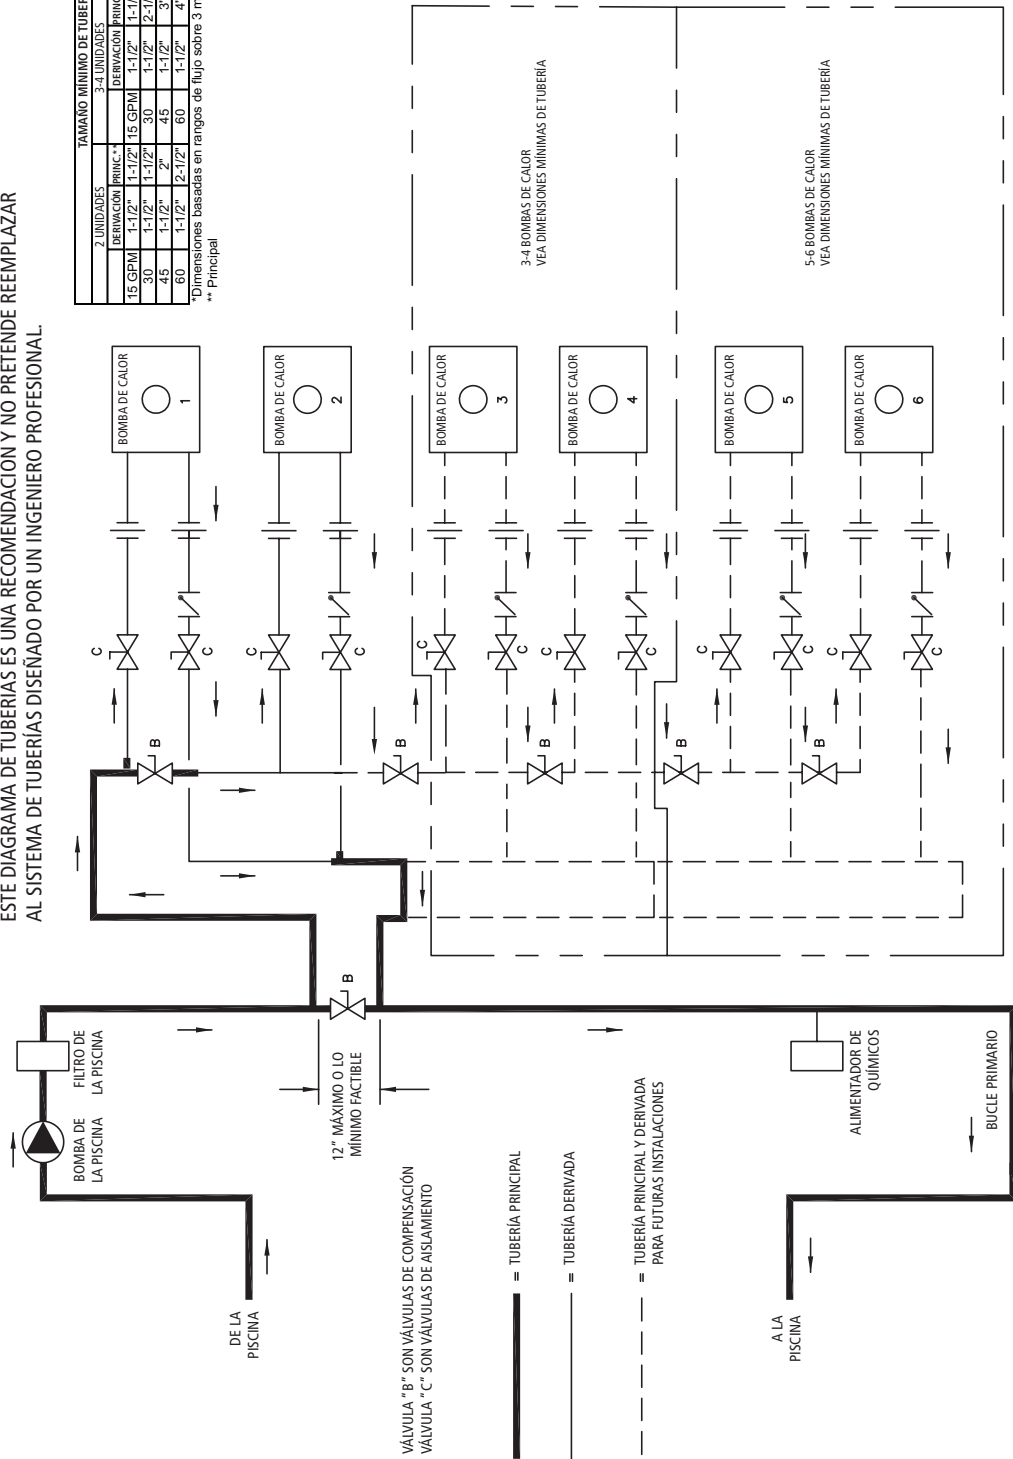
Tubería de piscina para calentador de bomba de calor y calentador de gas.
